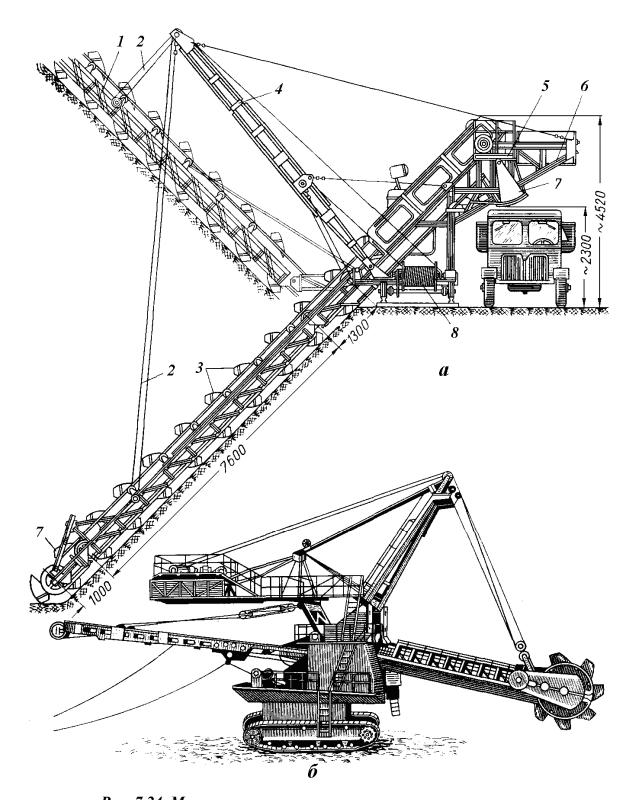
Многоковшовые экскаваторы поперечного копания: a – цепной; 6 – роторный; 1 – планирующее звено; 2 – подвеска; 3 – ковшовая цепь; 4 – стрела; 5 – ссыпной лоток; 6 – противовес; 7 – затвор; 8 – лебедка
